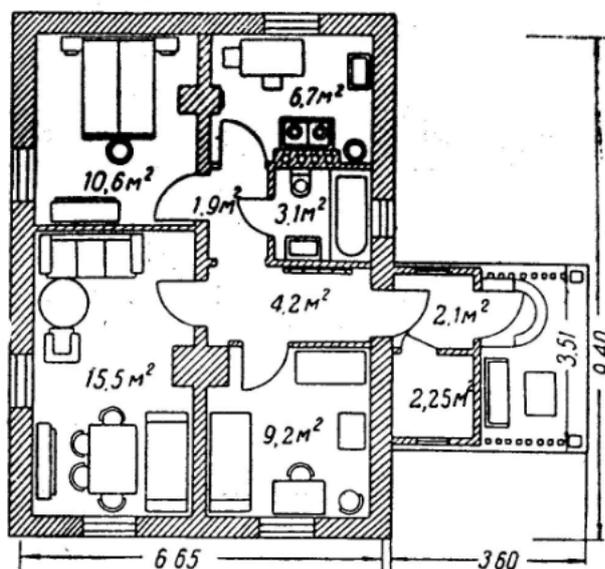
Одноквартирный трёхкомнатный кирпичный, с облегчёнными стенами жилой дом (жилая площадь 42,3 м², полезная площадь 52,0 м², K₁=0,81)
